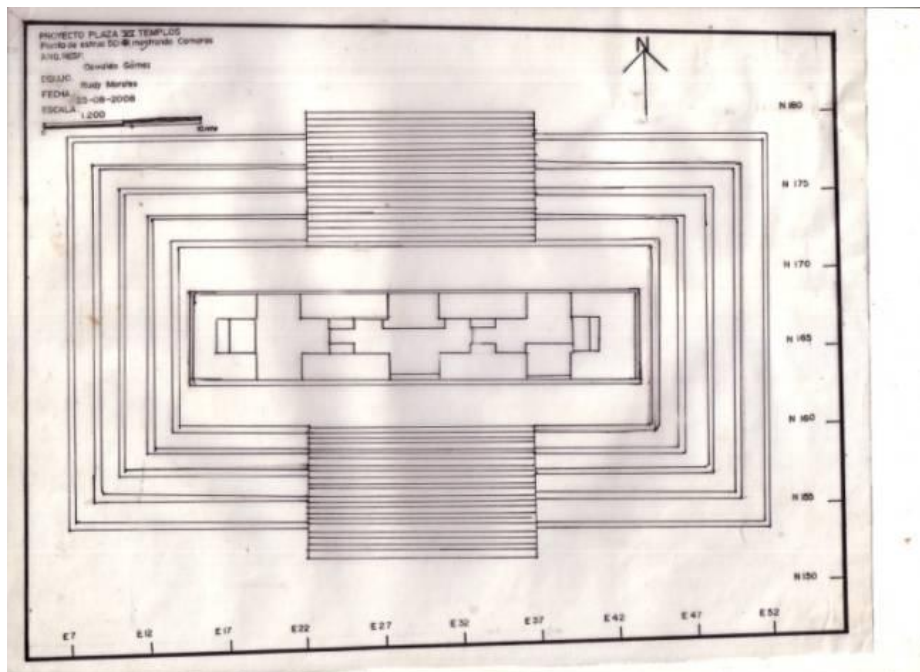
, Planta del Edificio 5D-91. Planta rectangular que muestra las cámaras en el interior del edificio. Dibujo de Rudy Morales.
